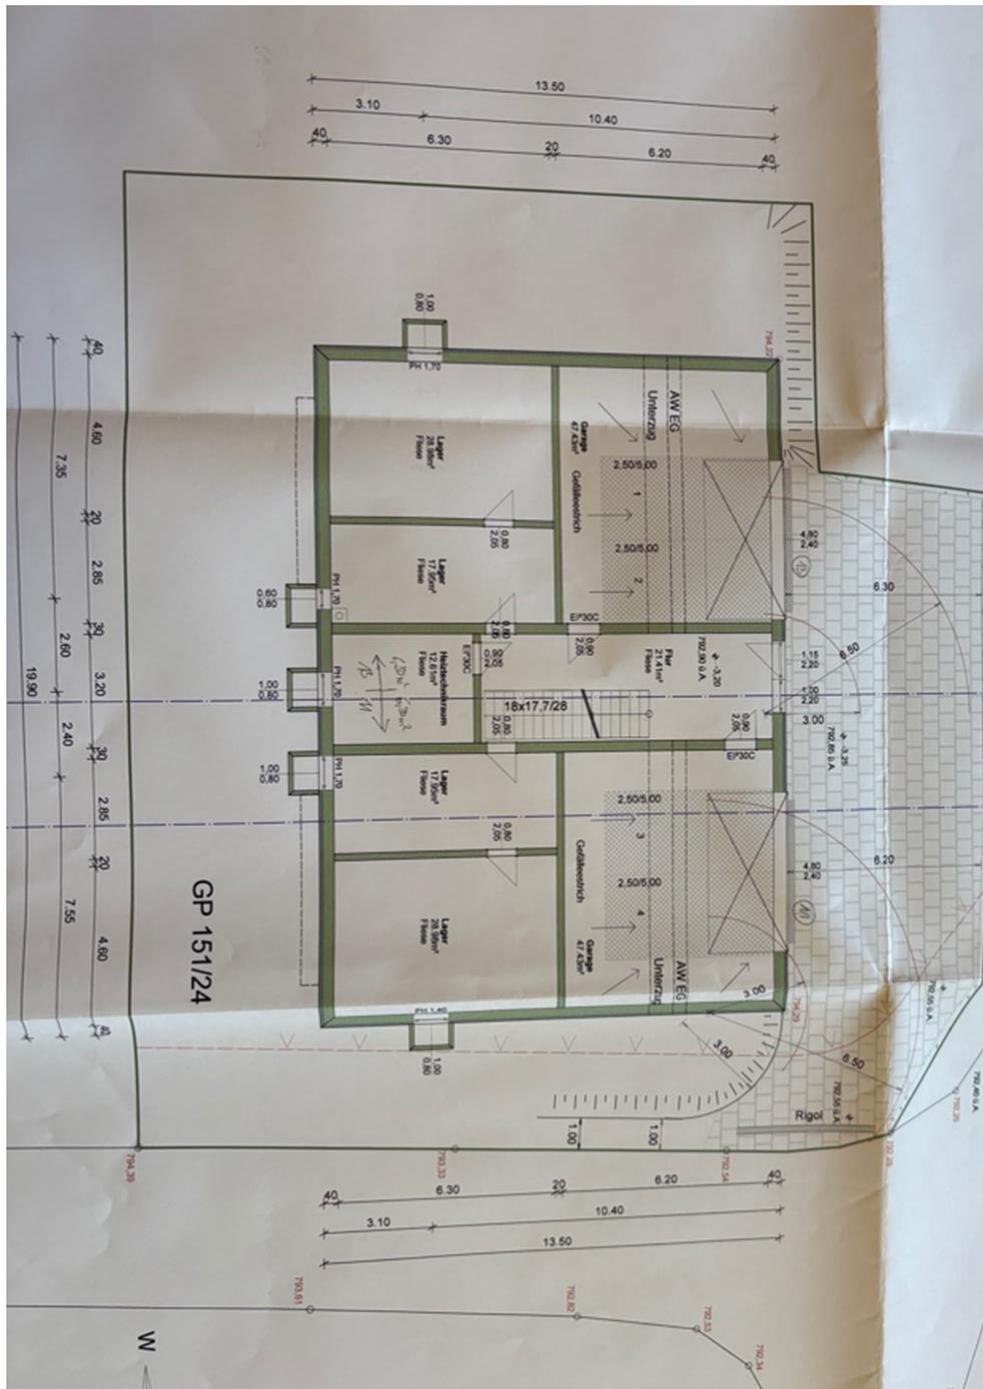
Grundriss Erdgeschoss (Einreichplan, v. 21.03.2017)
